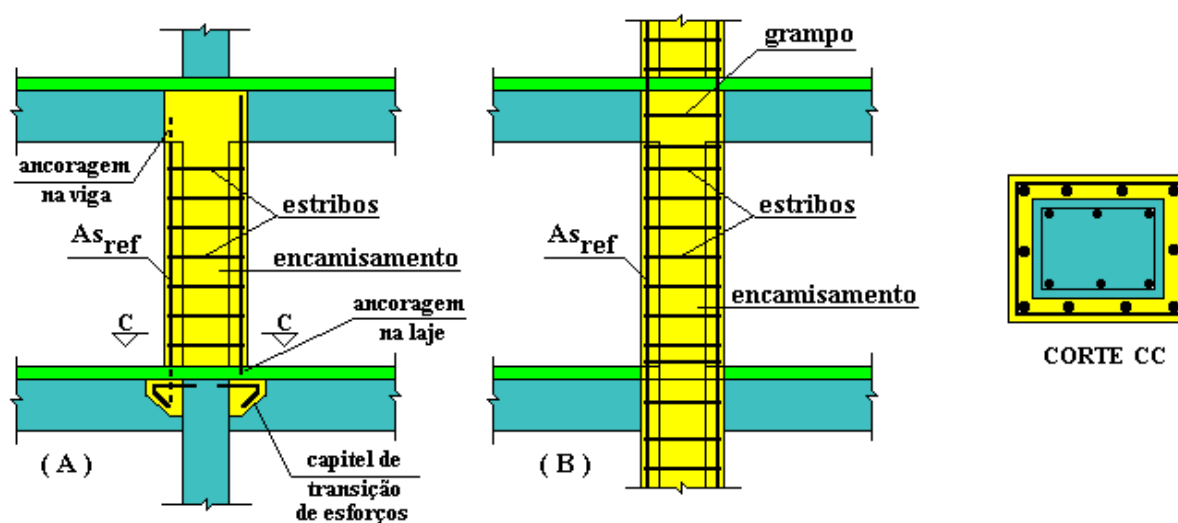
Reforço com concreto – concretagem pelo topo do pilar
